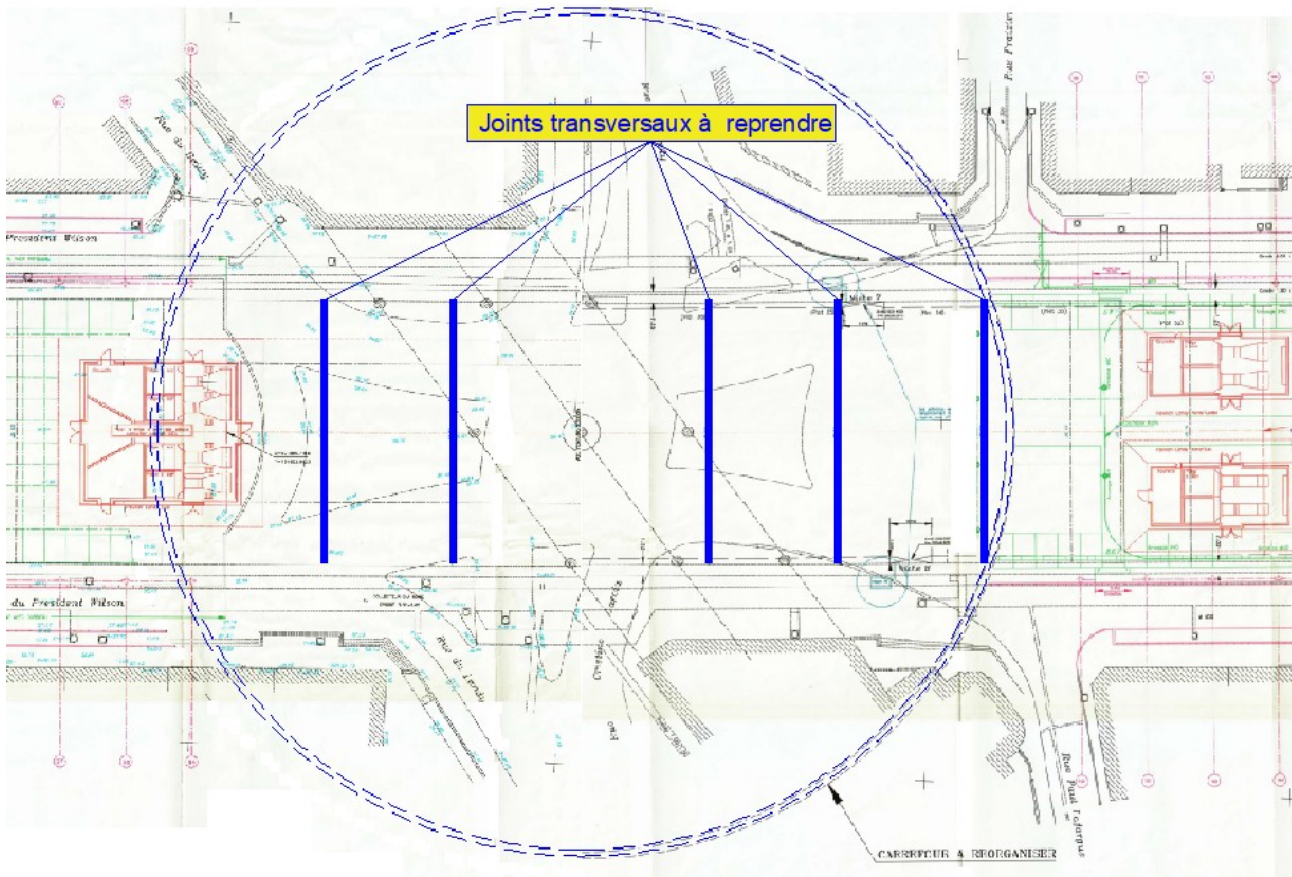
Extrait de la vue en plan des joints de chaussée du Pont de Soissons
